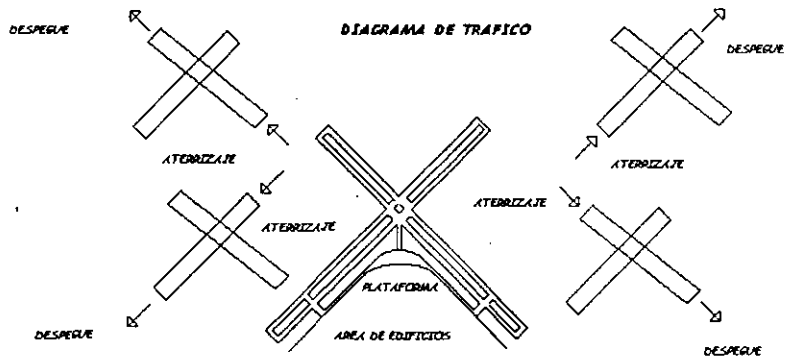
PROYECTO DE AEROPUERTO DE DOS PISTAS DE ATERRIJAZE CON INTERSECCION
